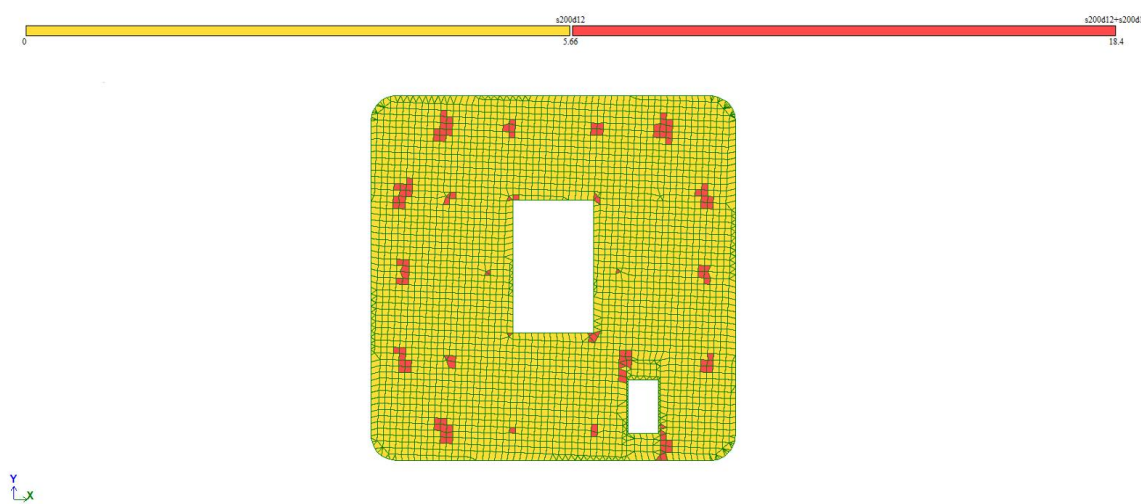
Верхнее армирование плиты перекрытия по оси Y
